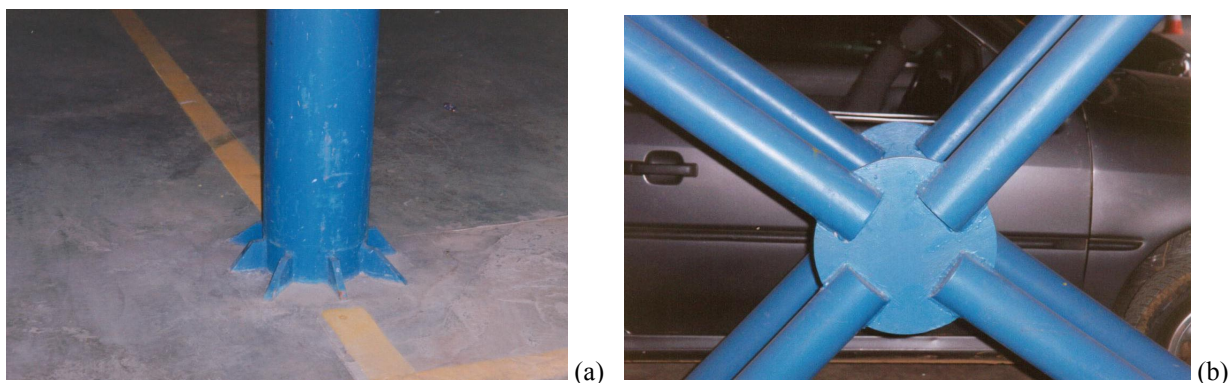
Vista interna da garagem: (a) detalhe base de pilar; (b) detalhe do contraventamento
